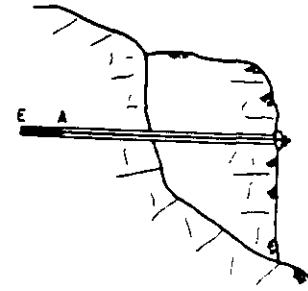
Anclaje activo. Empotramiento entre E y A.
